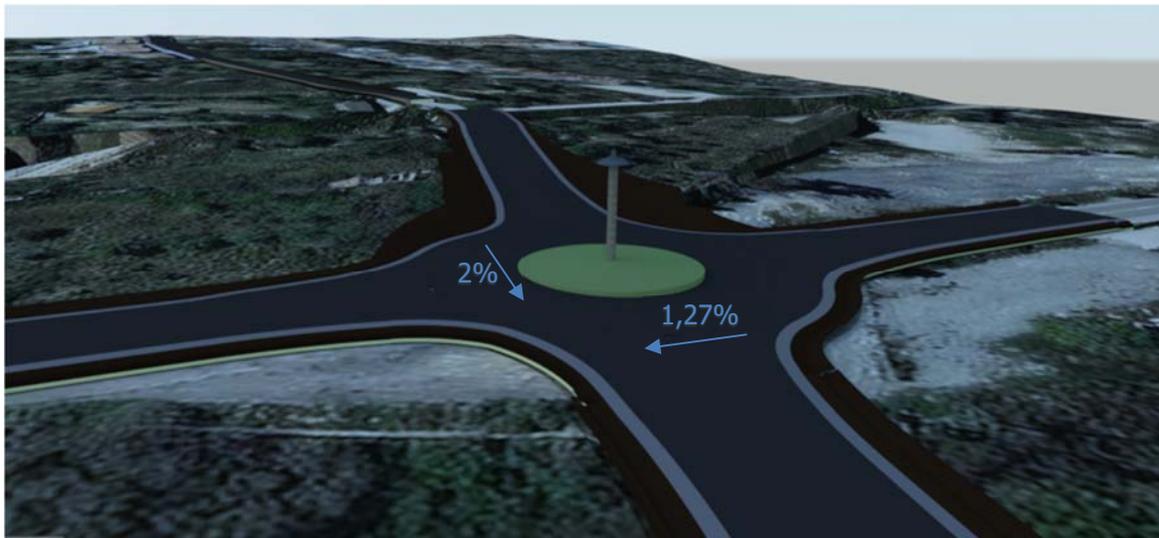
Plano de construcción de la rotonda renderizado en el software Naviswork
